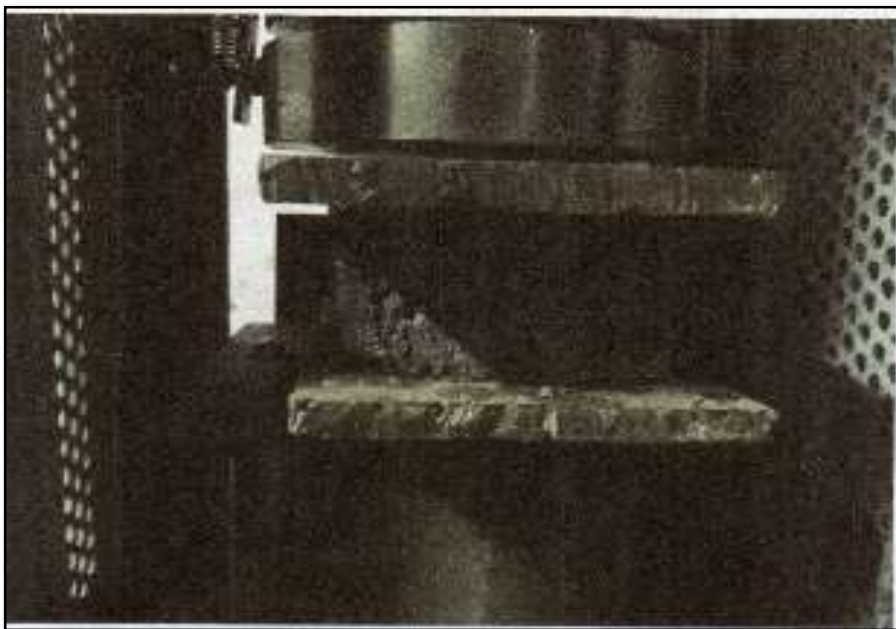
Se Observa el Ensayo a Compresión de los Adoquines de Concreto
